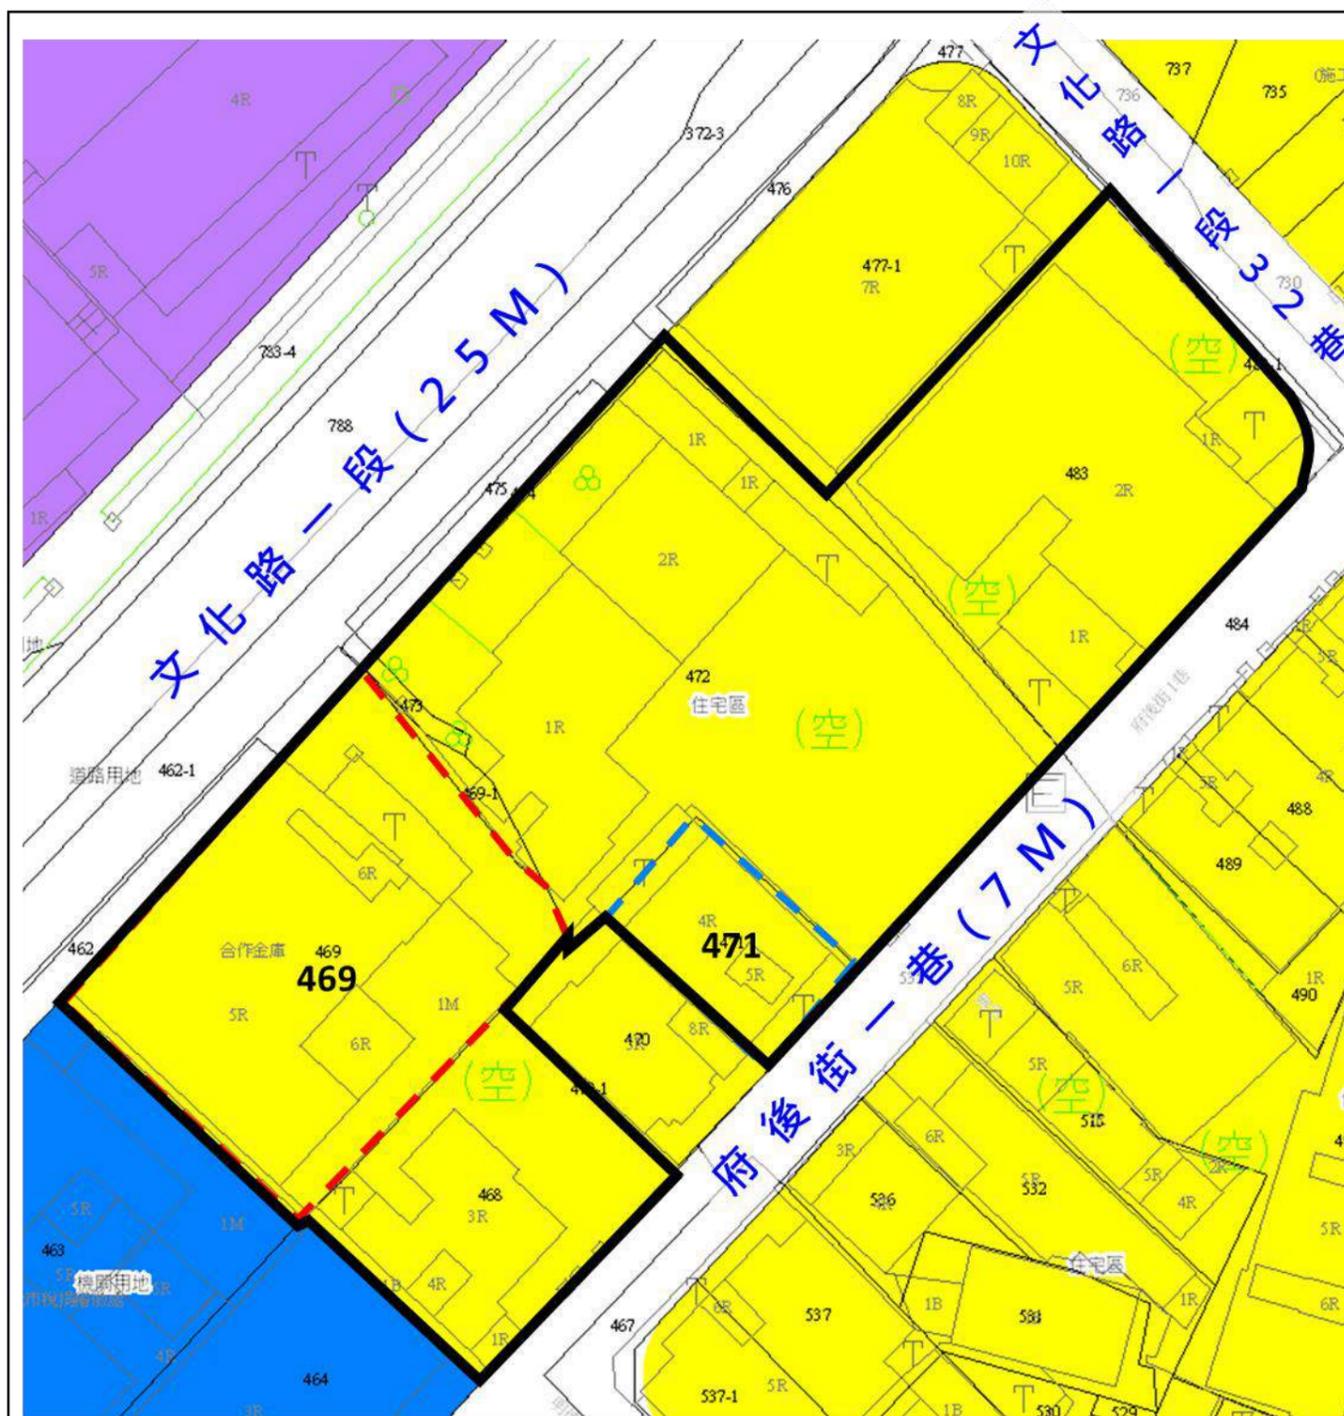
基地退縮建築平面套繪圖 SCALE 1/300
